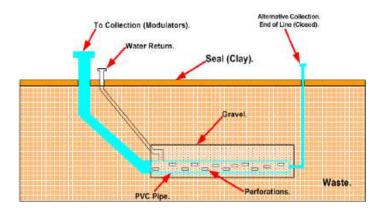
Pozo Horizontal para extracción de biogás en el relleno sanitario.
